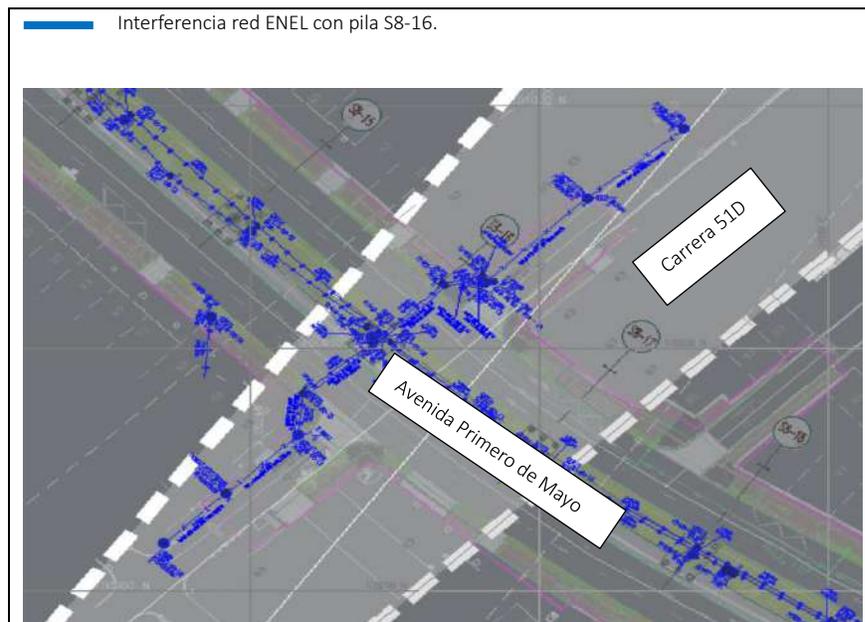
Plano de localización general de la red ENE 3-15
